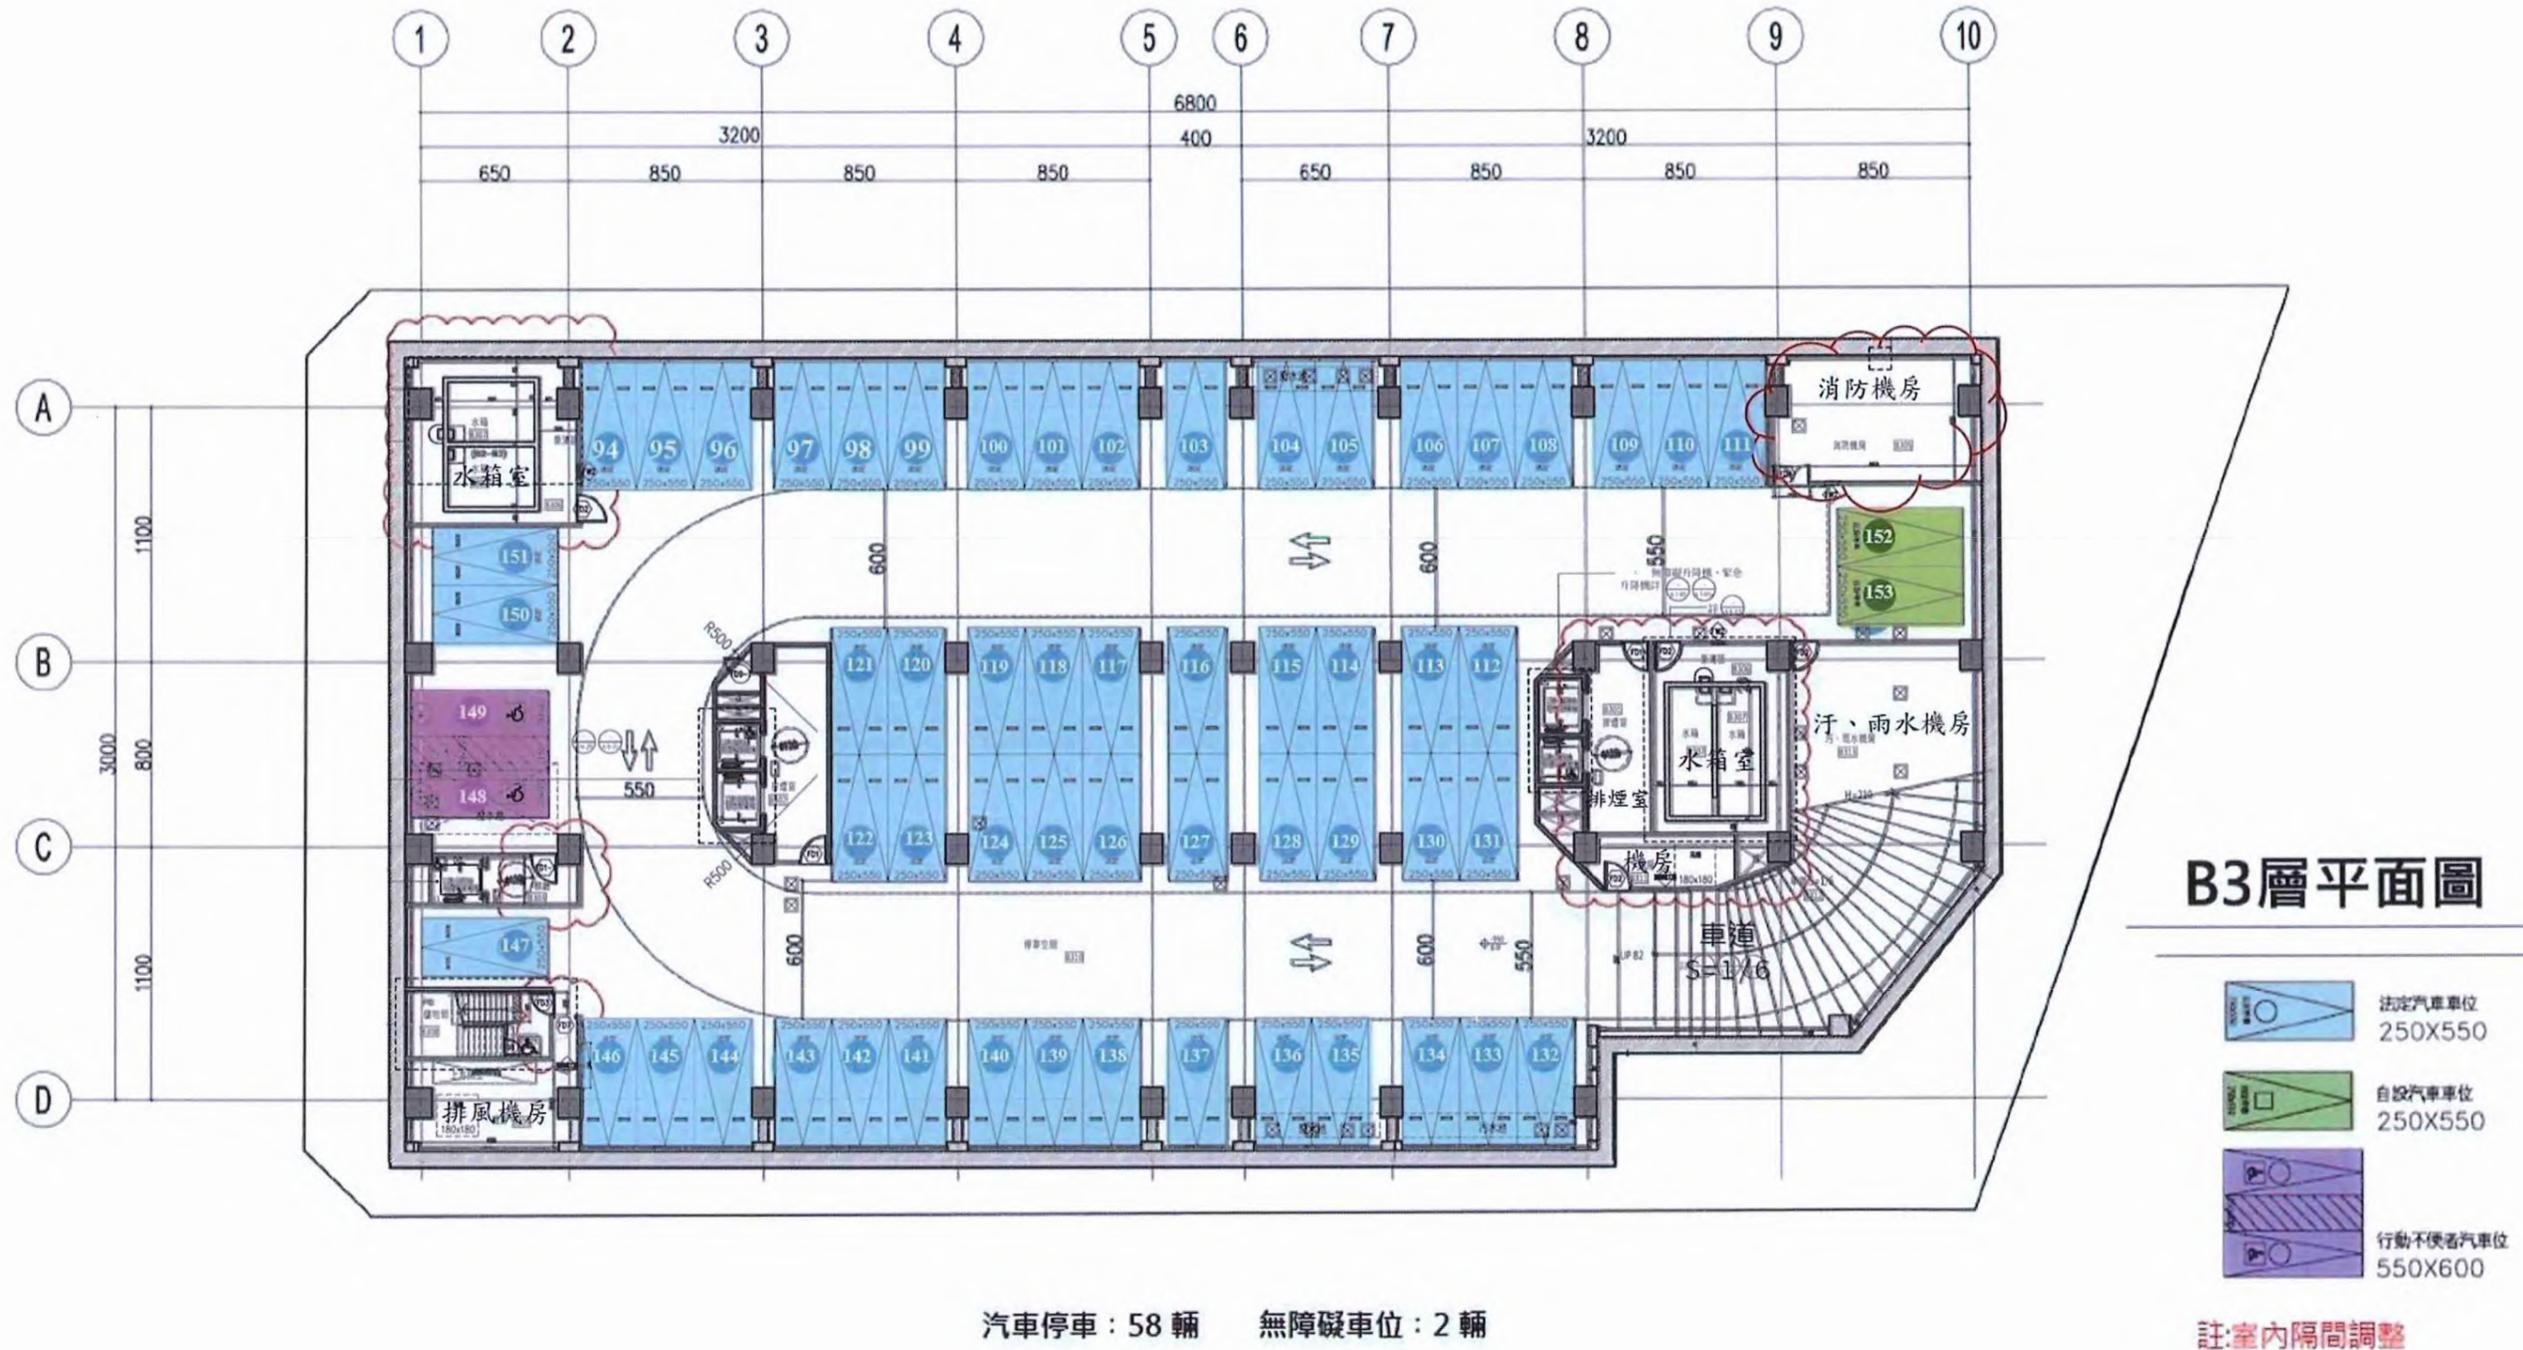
地下三層平面暨面積計算圖(S:1/300)
